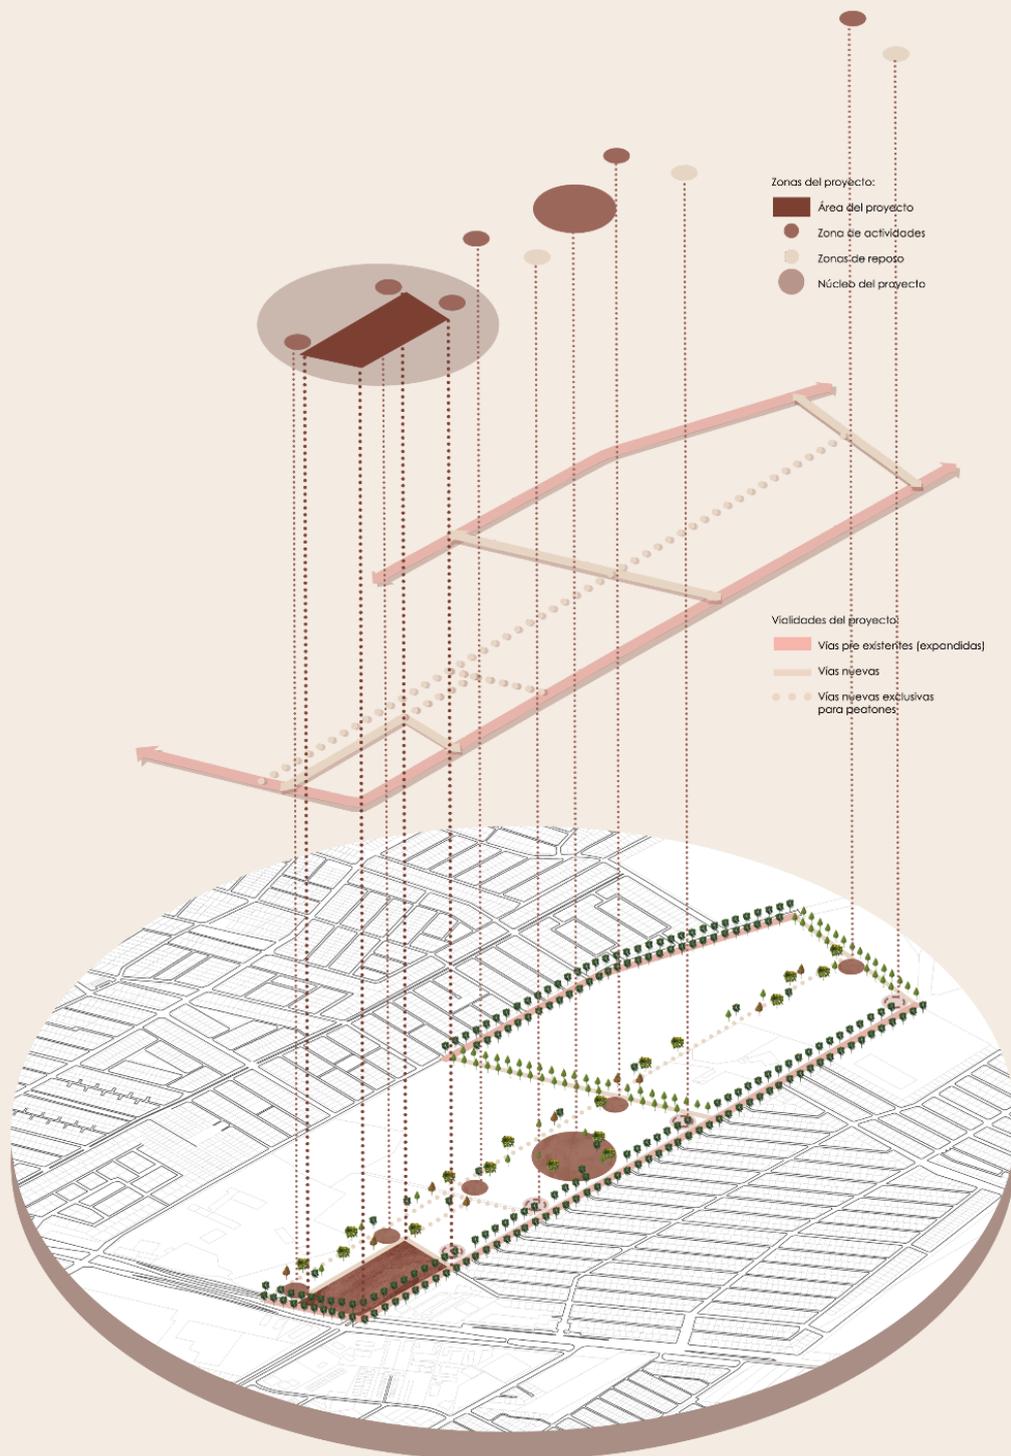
Plan maestro Explotado (Fuente elaboración propia)
